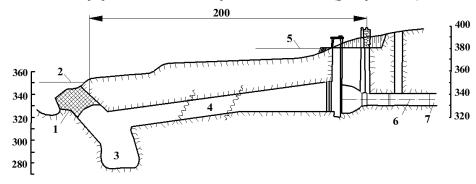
Продольный разрез водоприёмника тоннеля ГЭС Шют де Пасс. 1-скальный целик(пробка), 2-уровень воды в водохранилище при взрыве, 3-карман, 4-облисованный участок тоннеля, 5-наивысший уровень воды в водохранилище, 6-подводящий тоннель, 7-временная бетонная пробка.
